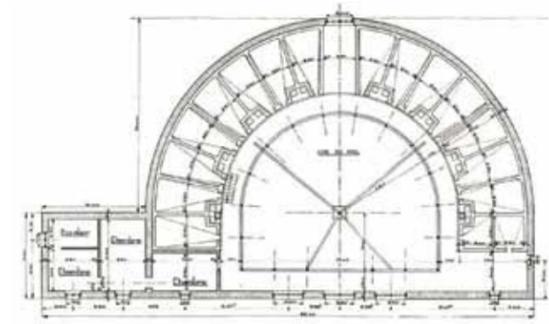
Cave coopérative de Saint-Théodorit. Plan. Henri Floutier, architecte (A. D. 30, 7 M 44).
